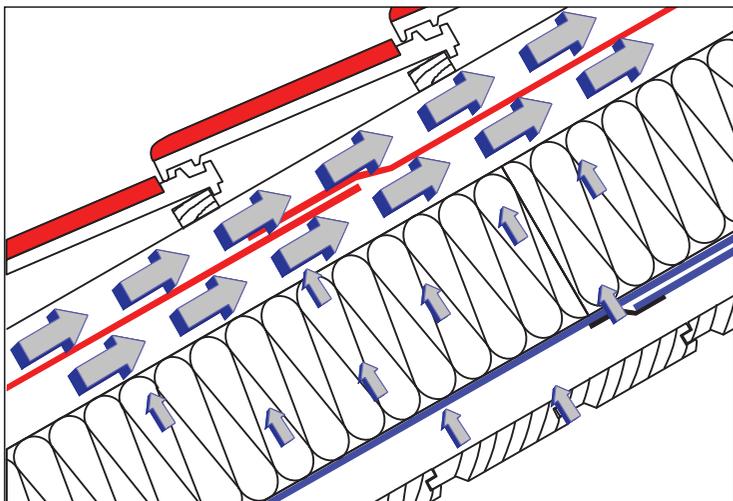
Конструкция крыши с двухслойной вентиляцией
